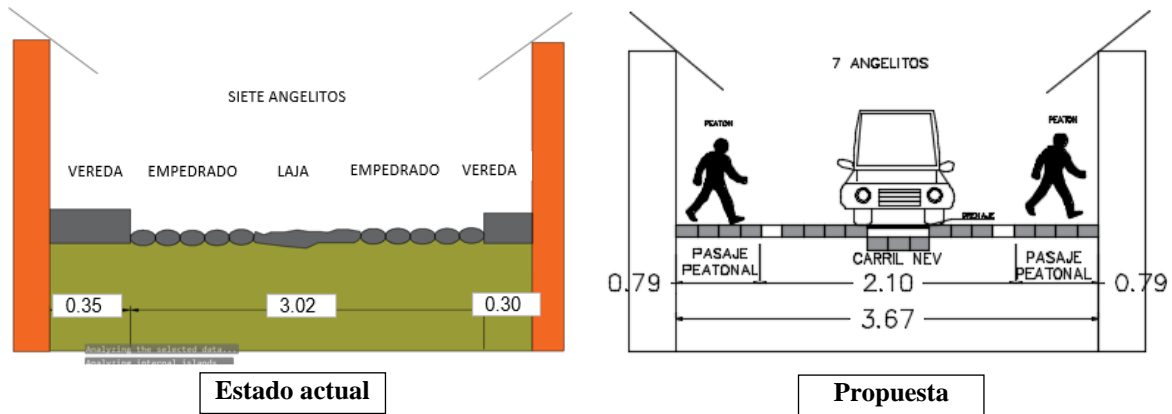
Propuesta de la sección transversal para la calle 7 Angelitos
